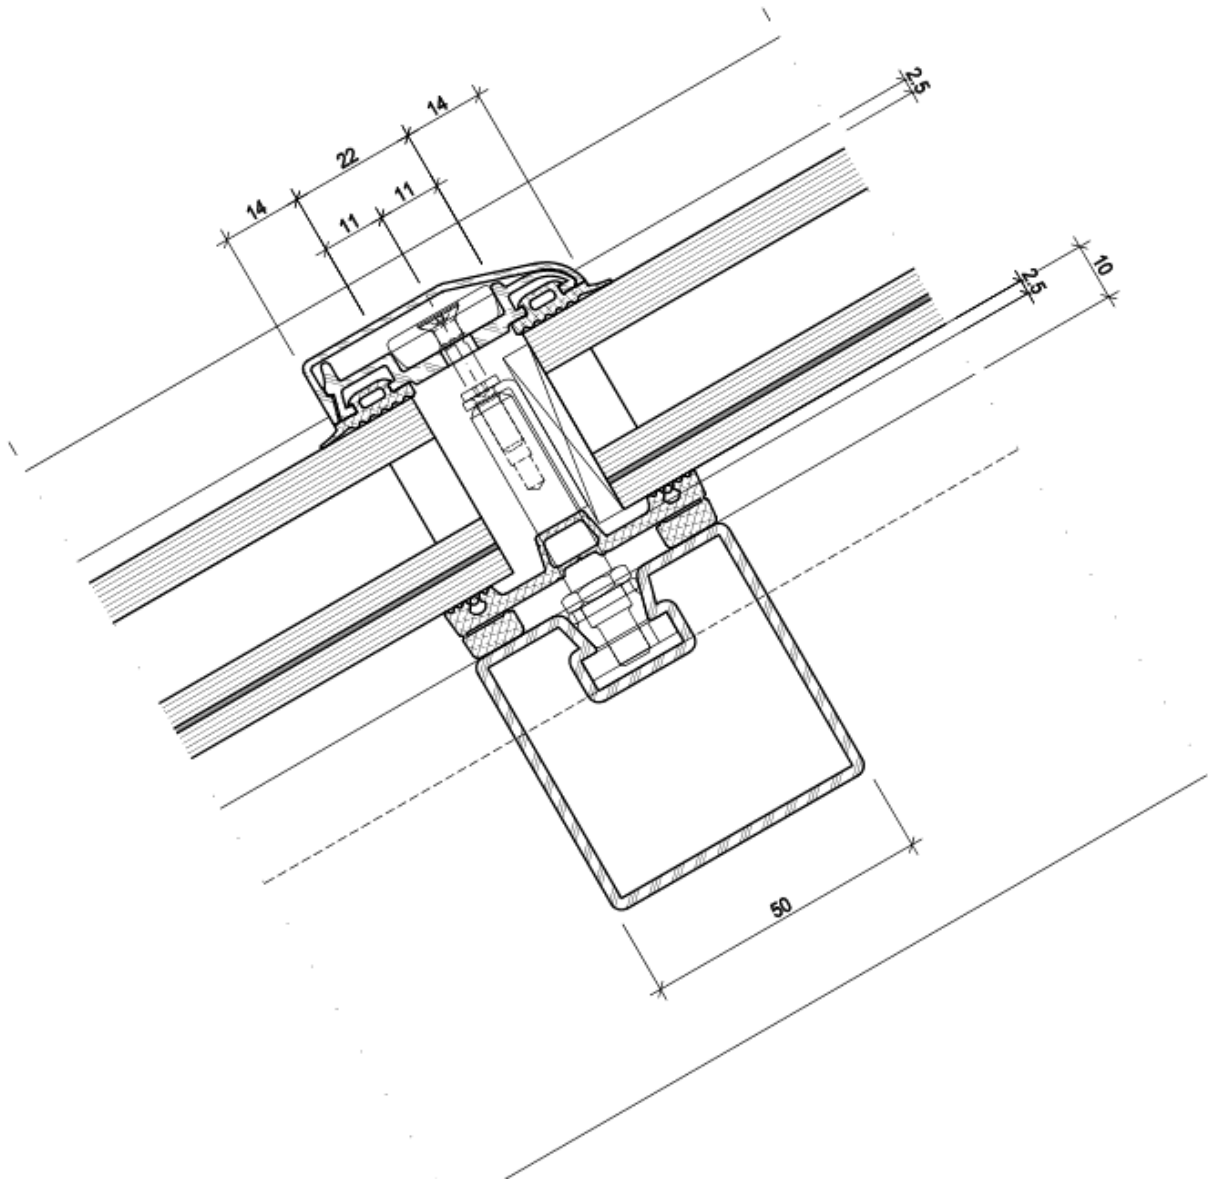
Prise en feuillure VISS façade verrière – 50 mm - Traverse
